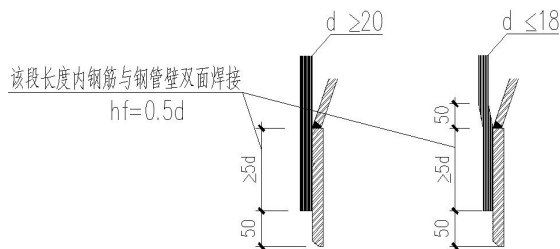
劲性柱纵向钢筋与上下段矩形钢管壁外侧焊接示意
